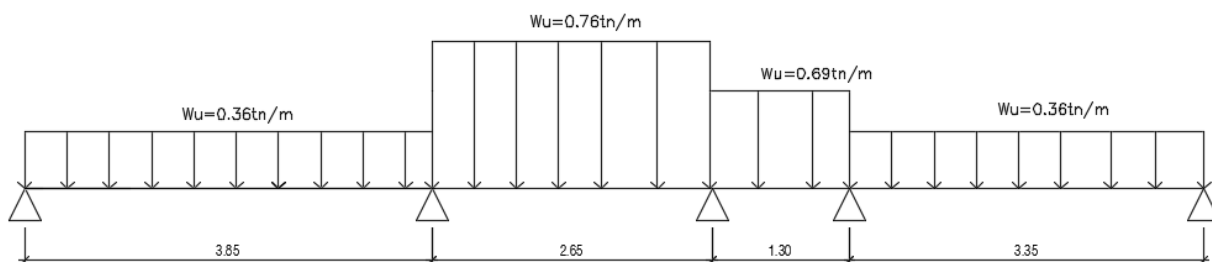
Distribución de cargas ultimas actuantes en sección de losa maciza
